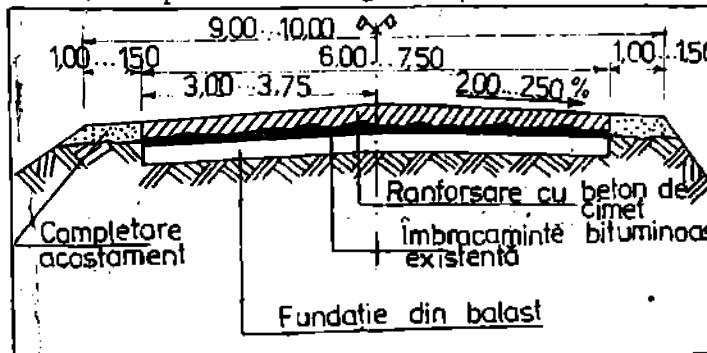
Secțiunea transversală a unui drum renforșat cu îmbrăcăminte din beton de ciment.
